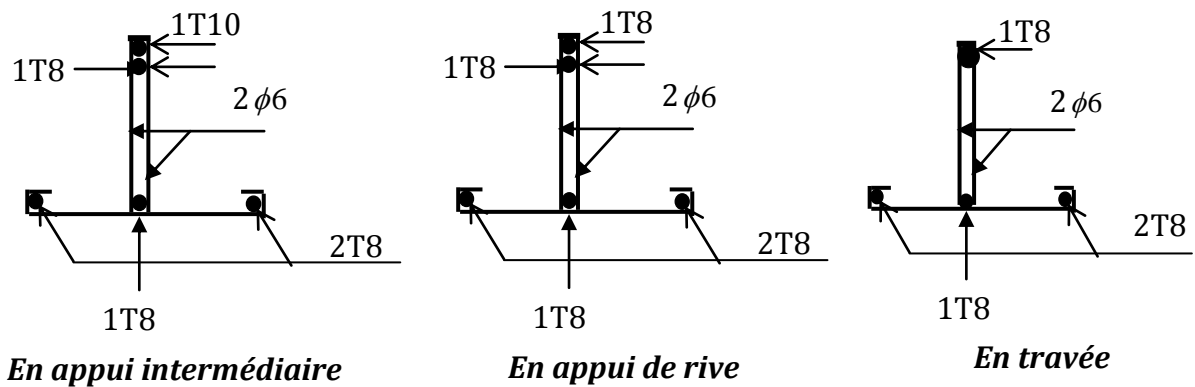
Schémas de Ferrailage des Poutrelles de planchers étage courant
